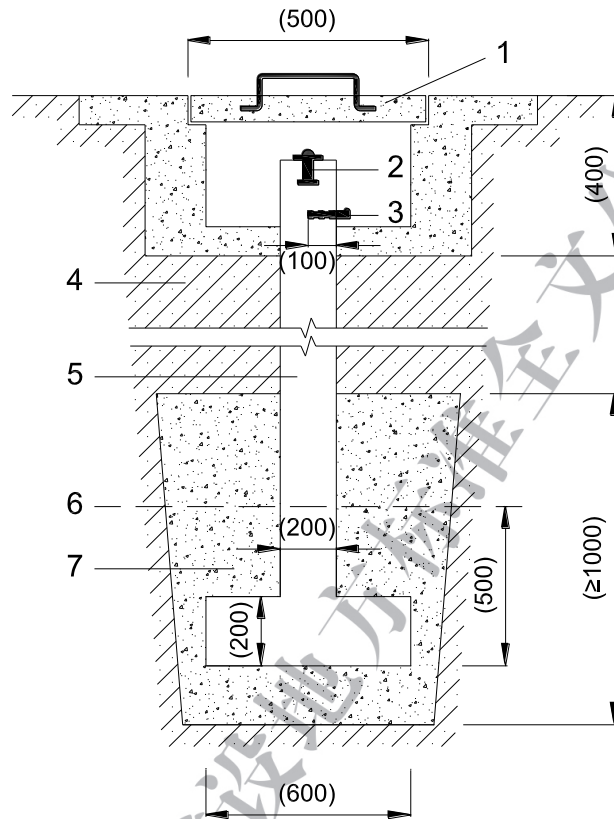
混凝土水准基准点标石埋设（单位：mm）
